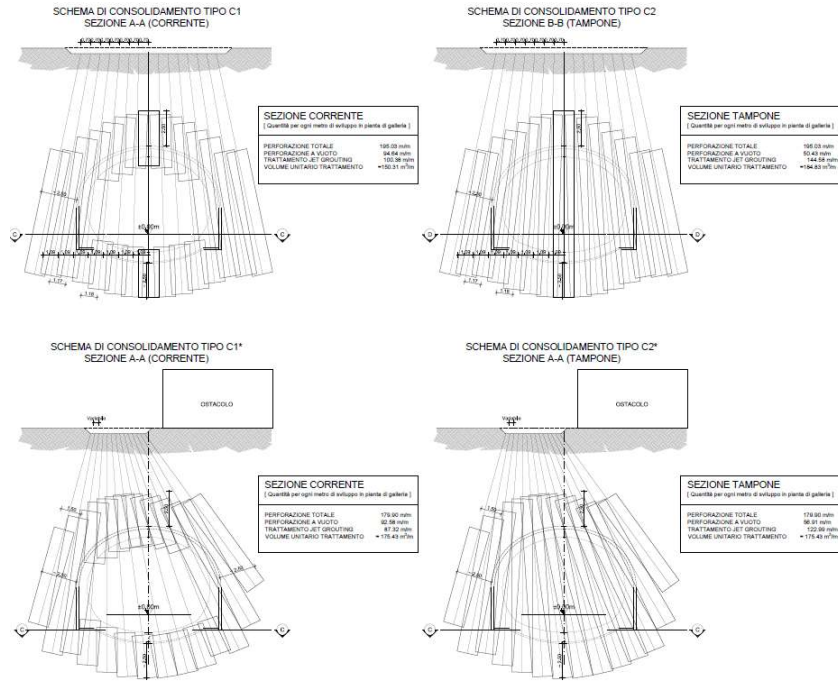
Sezione tipo 1 – Tipologie di consolidamento con colonne di Jet Grouting
